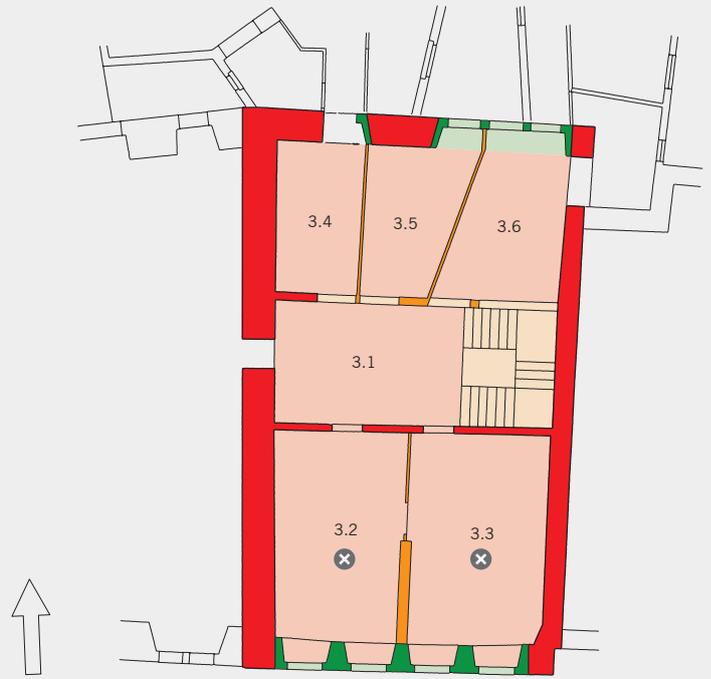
Zug, Ägeristrasse 9, Grundriss des dritten Vollgeschosses.
